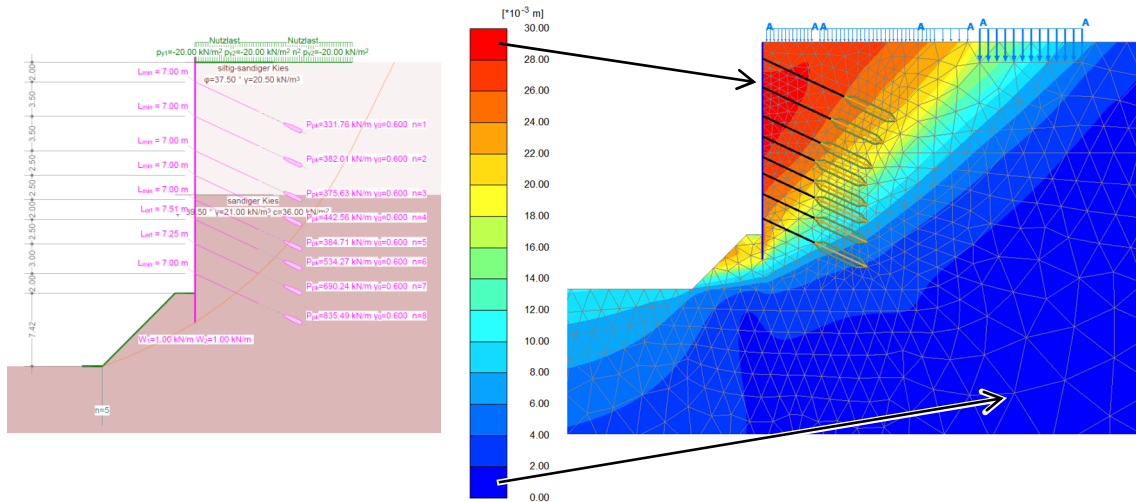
Bemessungsmodelle: Stabstatik-Modell (links), 2D FEM (rechts)
